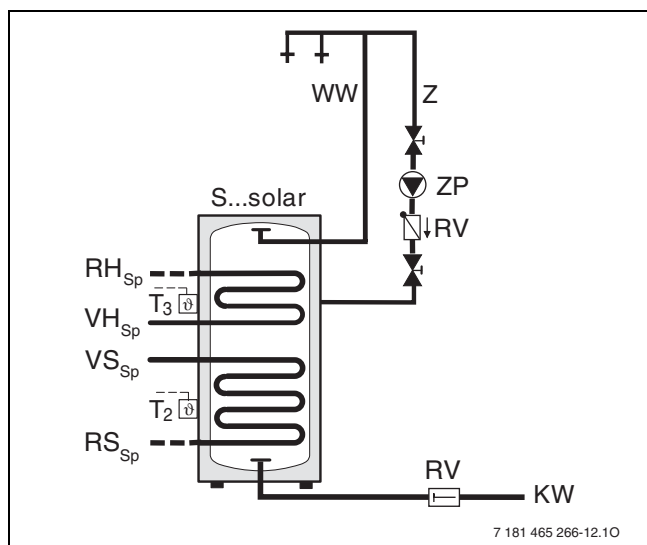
Trinkwasserseitiges Anschluss-Schema bei solarer Warmwasserbereitung
